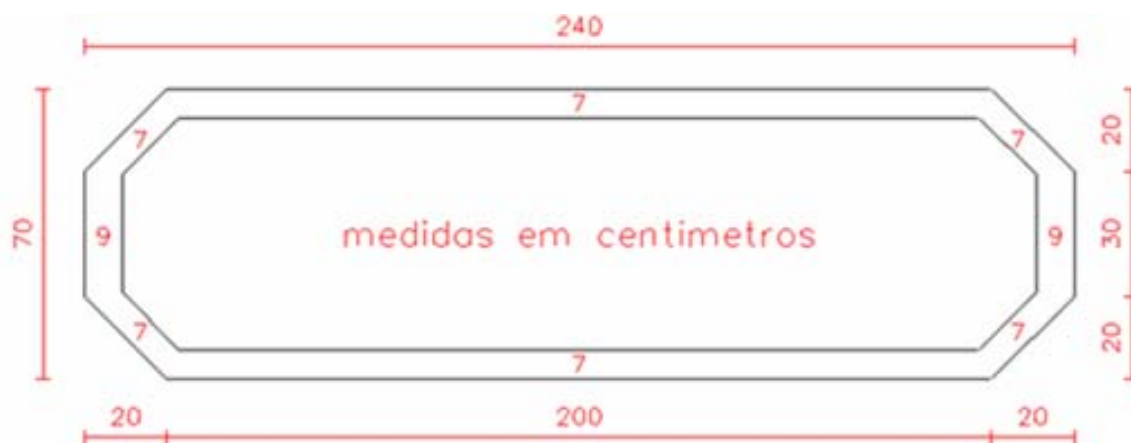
Detalhe da seção transversal da aduela (medidas em cm).
